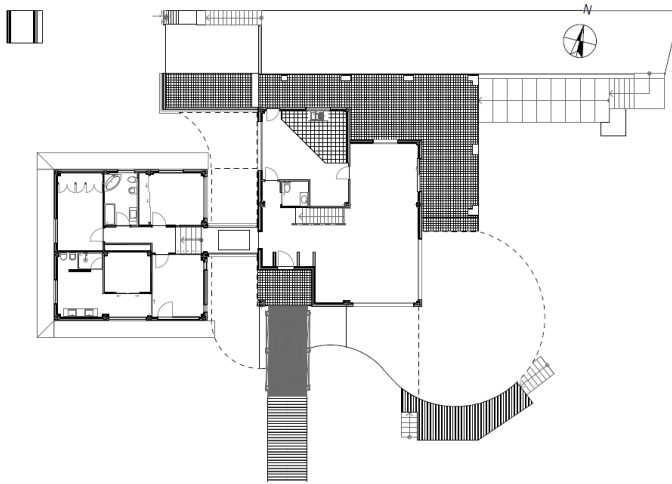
Planta Baja. Fuente propia. Archicad 20. 2018
